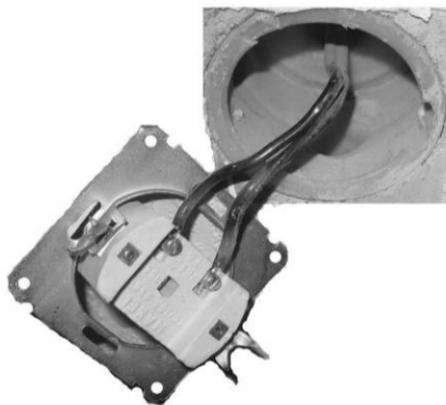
Розетка для скрытой проводки с подключенными проводами
